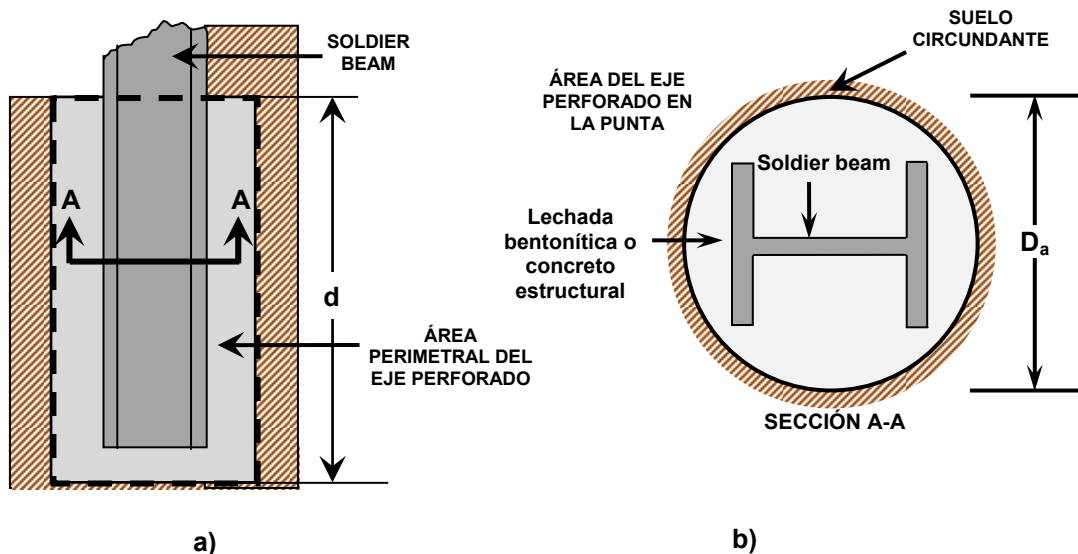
a) Vista del área perimetral. b) Vista de la sección en la punta del soldier beam.
